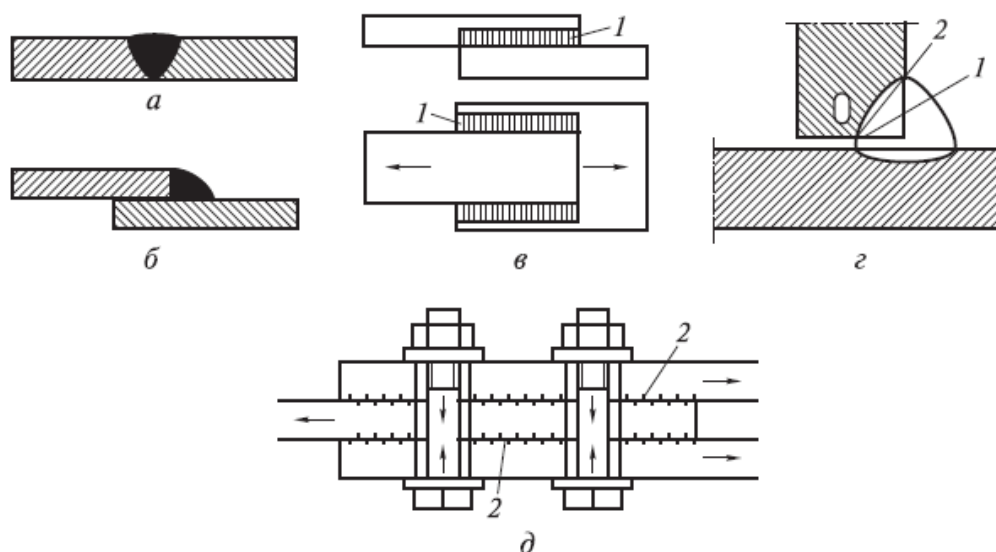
Основные виды соединений металлических элементов в мостах: а — стыковой шов; б — угловой лобовой шов; в — угловой фланговый шов; г — расчетные сечения угловых швов (0—1 и 0—2); д — схема работы соединения на высокопрочных болтах; 1 — фланговый шов; 2 — плоскости передачи усилия трением
